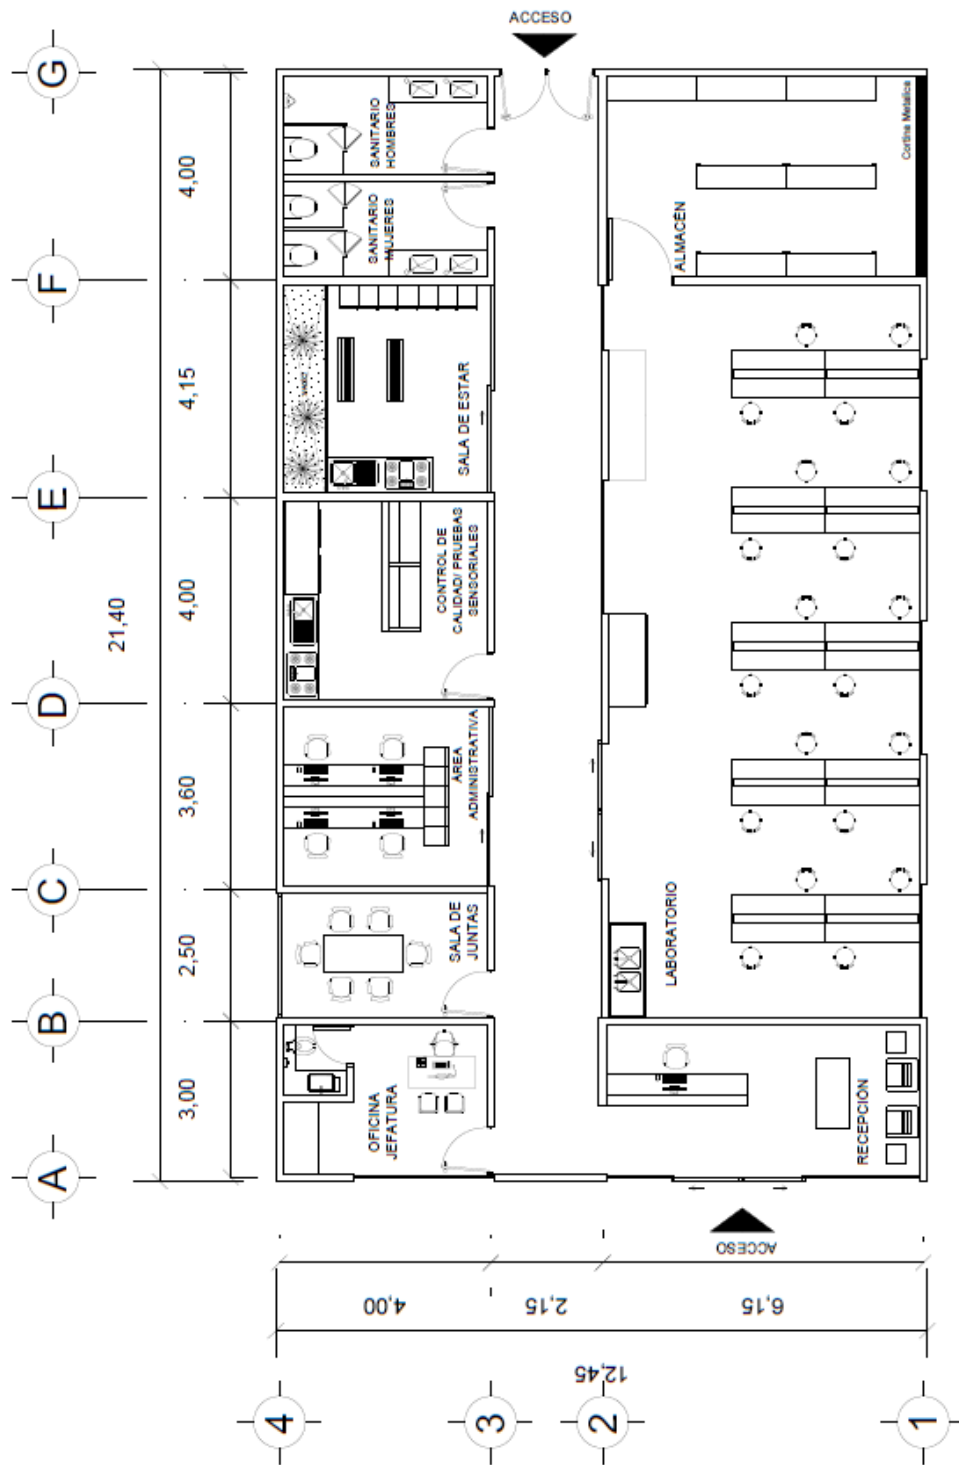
Planta piloto de producción de agitadores con sucralosa fijada
